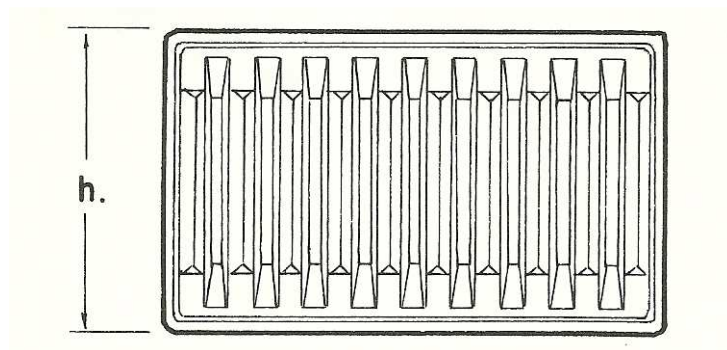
Vista frontal de radiador de panel de chapa de acero
